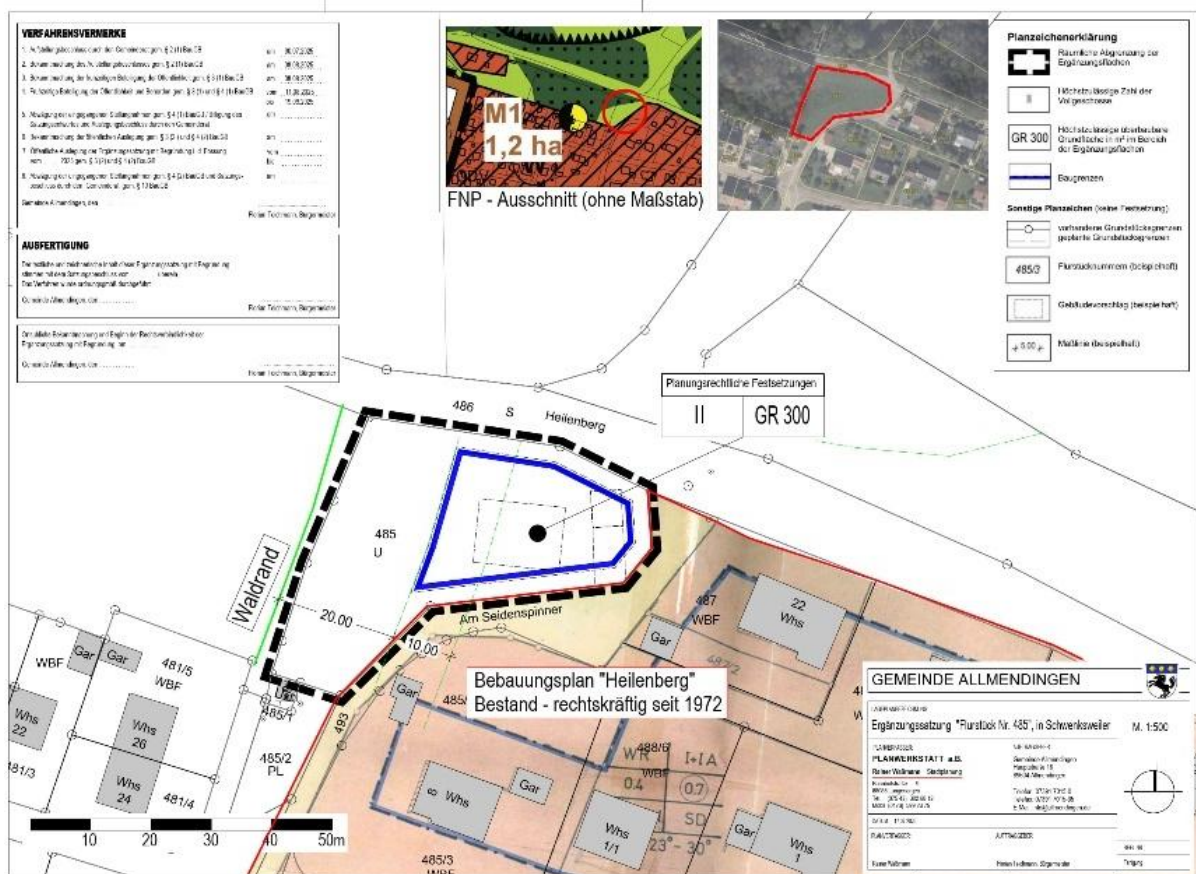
Städteplanerischer Entwurf vom 17.07.2025 zur Ergänzungssatzung "Flurstück Nr. 485", in Schenkweiler.
